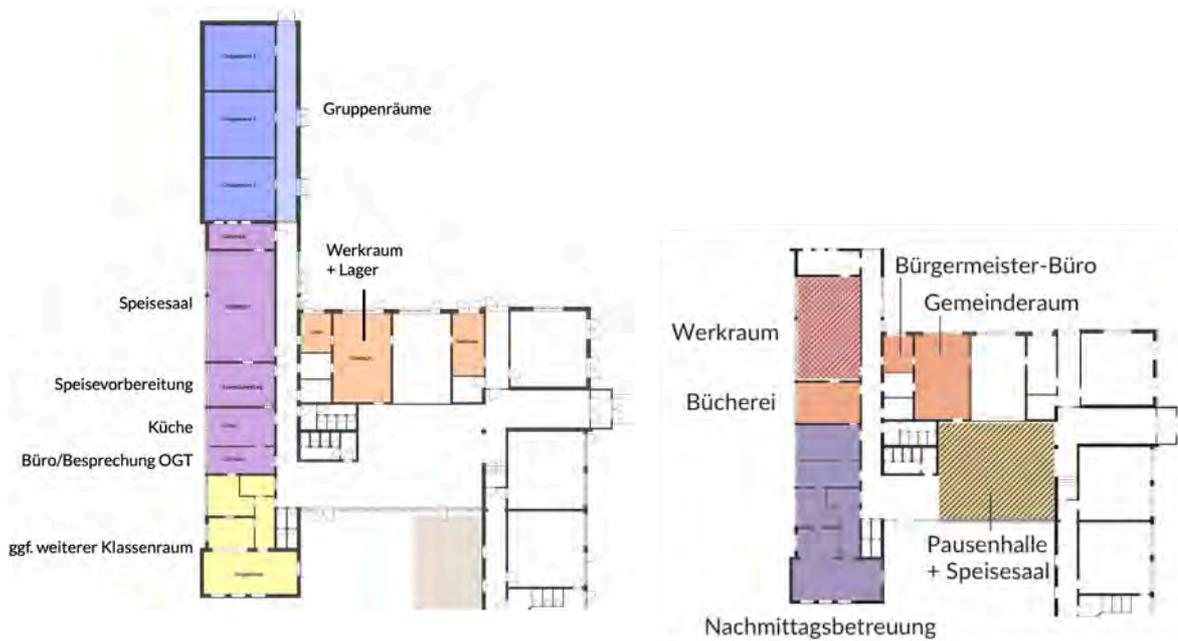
Grundriss Anbau an die Schule (links, o.M.) und Grundriss Bestandssituation (rechts, o.M.)
